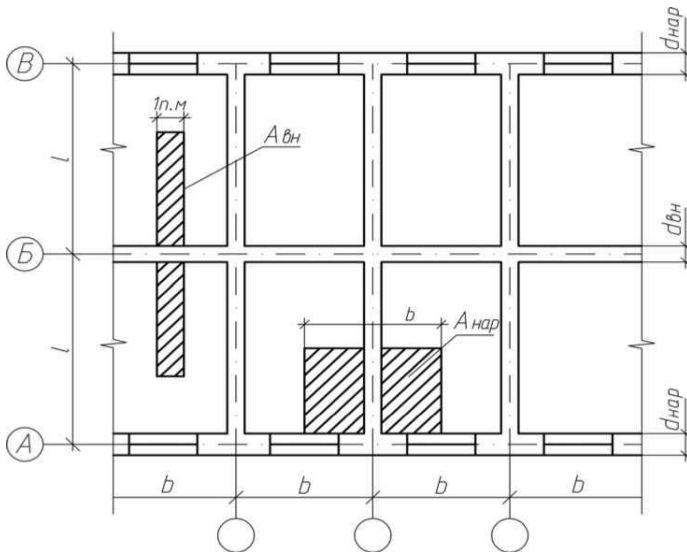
Схема будівлі та розрахункова схема до визначення вантажних площ для типових перерізів.
